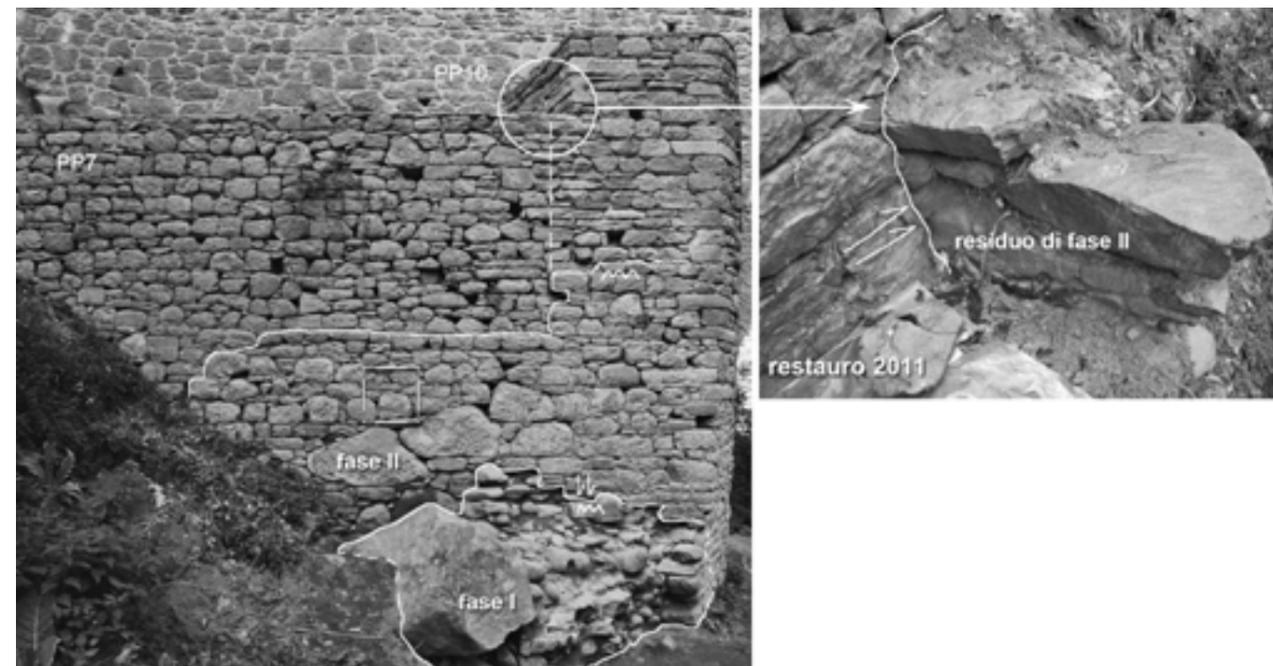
, Panoramica del muro di risvolta PP 7 con evidenziati i limiti delle strutture precedenti il ponte attuale: la sostruzione (fase I) e la muratura in appoggio ad essa (Fase II).
